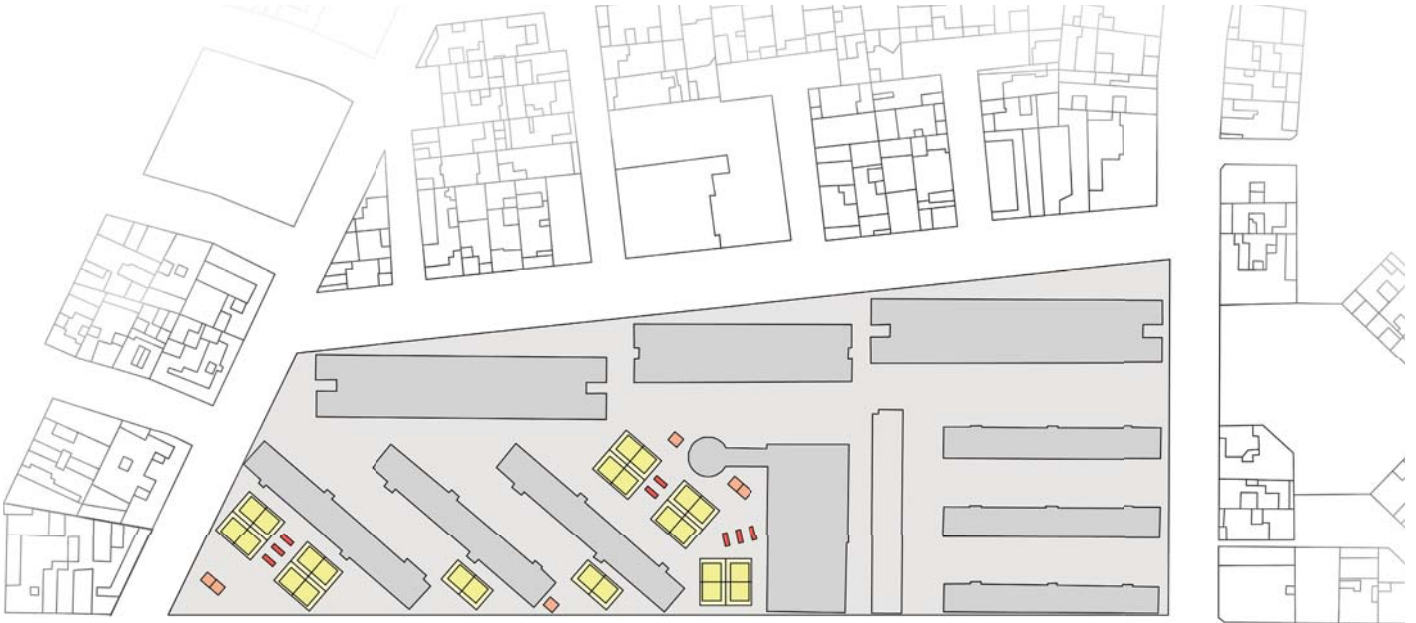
Planta de conjunto. Propuesta de emplazamiento para el Multifamiliar Tlalpan, CDMX.
